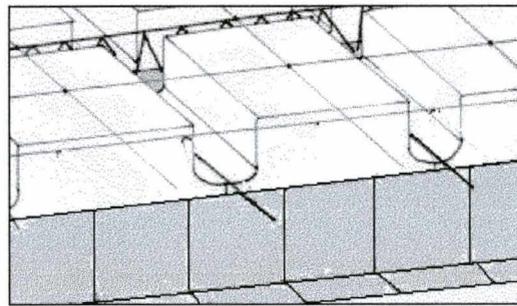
Laje com vigota treliçada armada nas duas direções.
